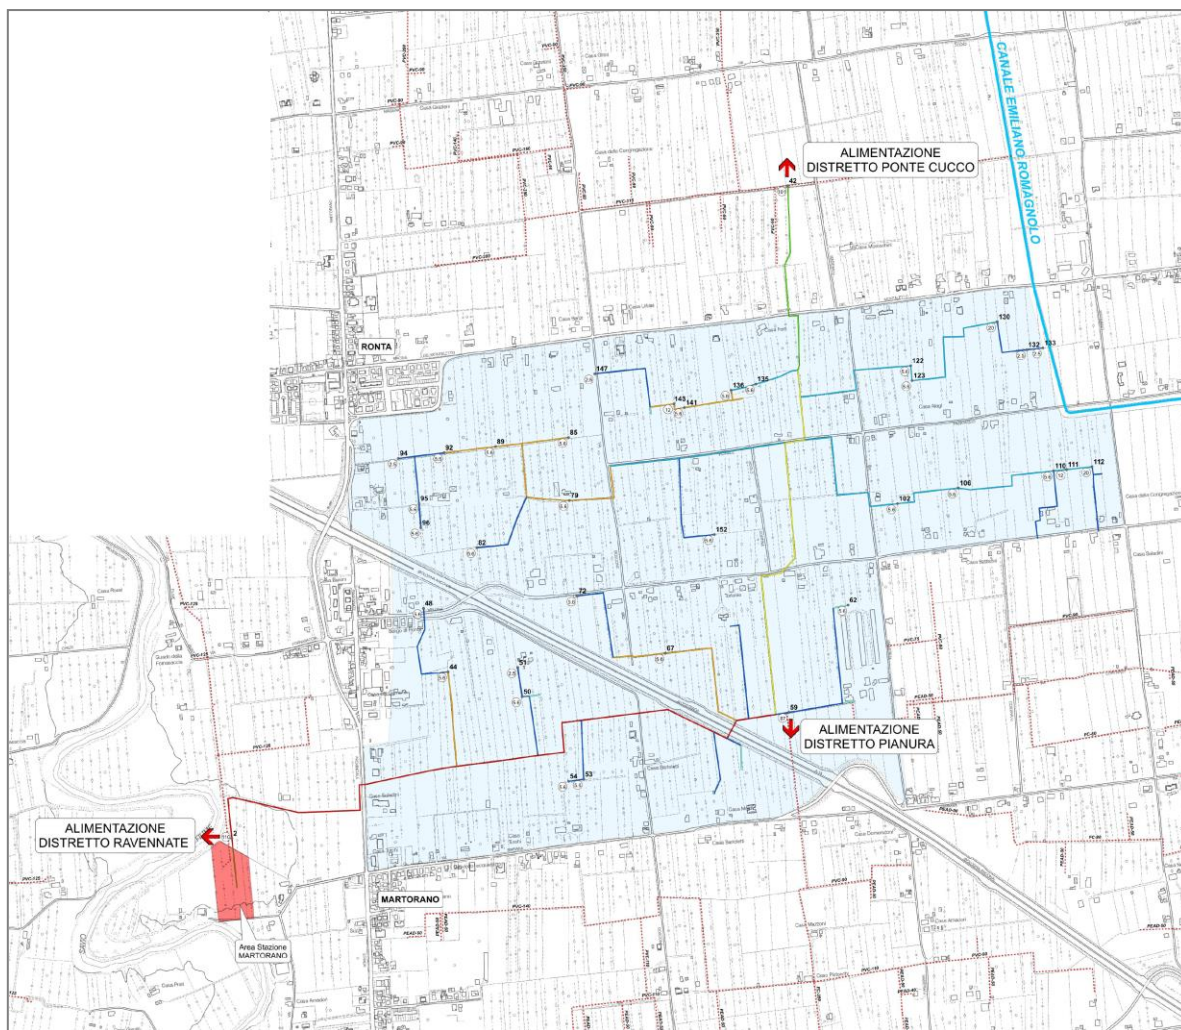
planimetria con l'ubicazione dei lotti della infrastruttura.
